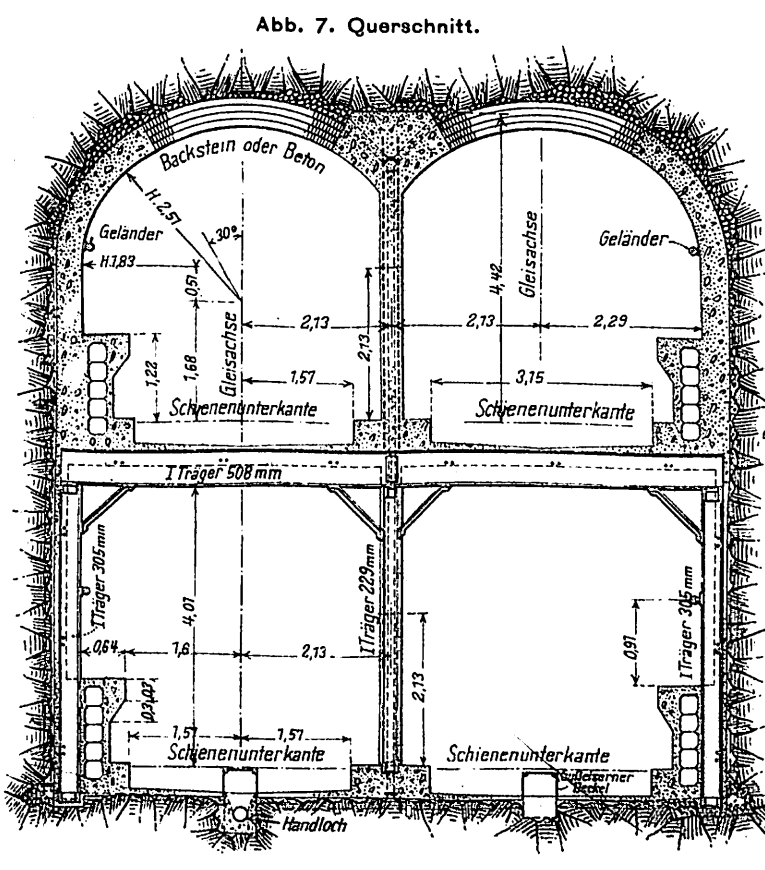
und 8. Ganz als Tunnel gebautes, zweigeschossiges Bauwerk. Maßstab 1:105
